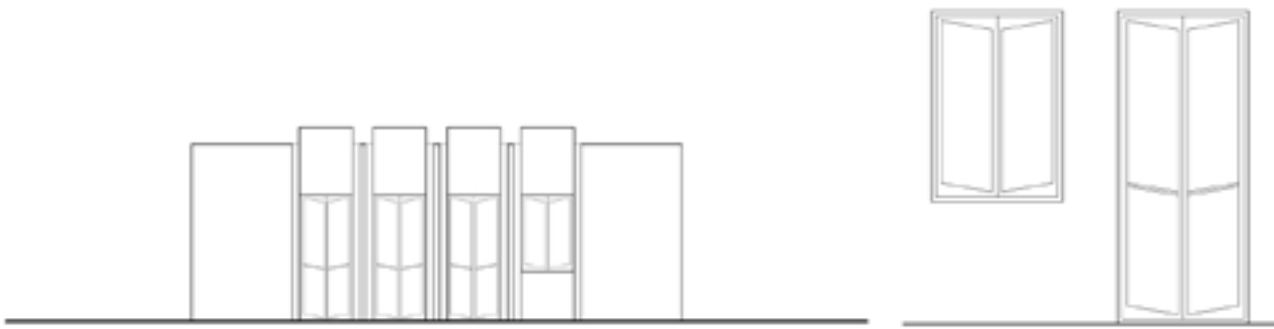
Alzado este de la casa Duncan. Dibujo del autor.
